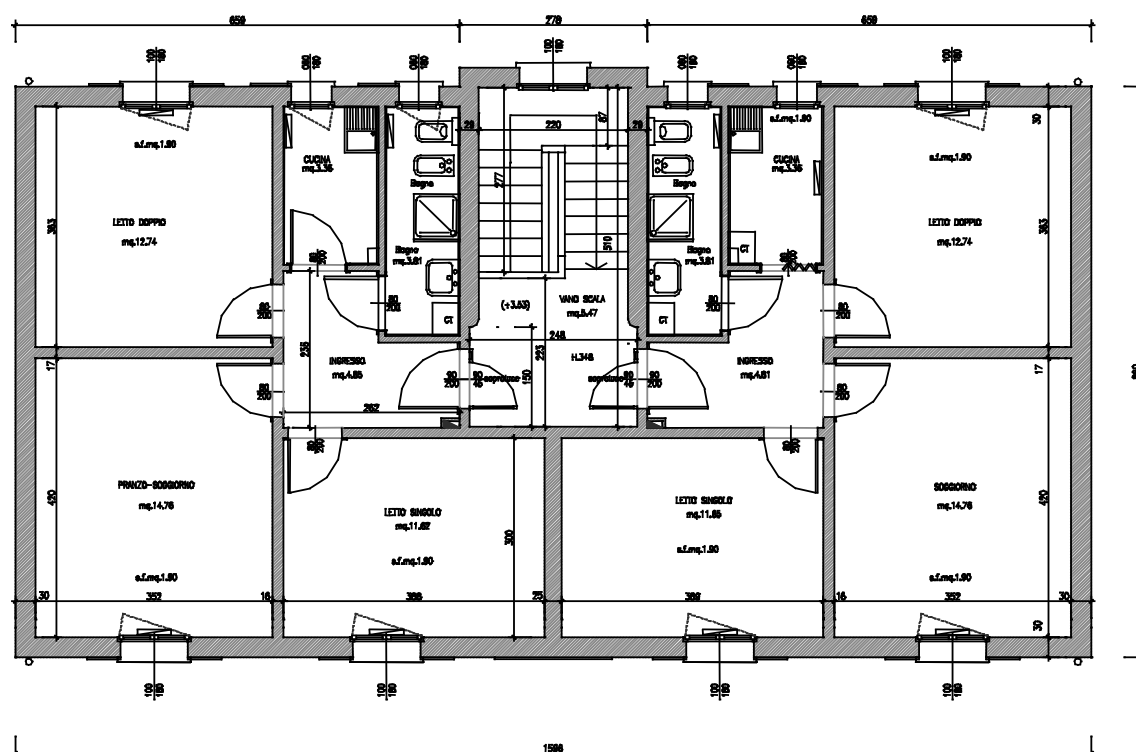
PALAZZINA TIPO B: Pianta Piano Primo – Stato di Fatto
